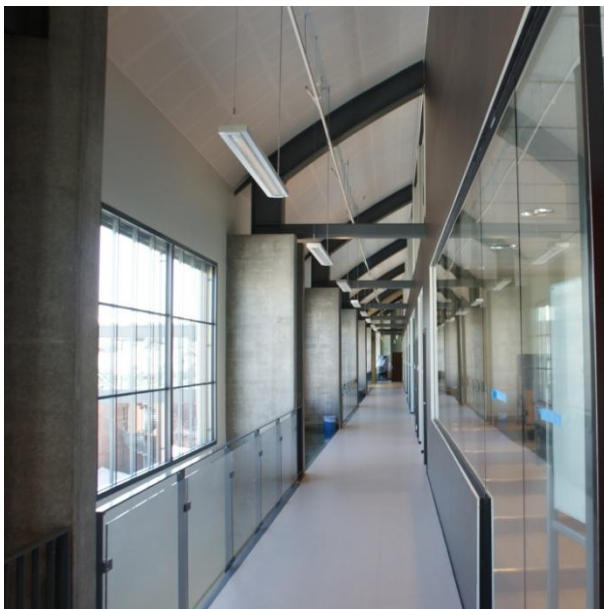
Eksisterende bærekonstruksjon kan være en utfordring. (Skårdal og Strand)
